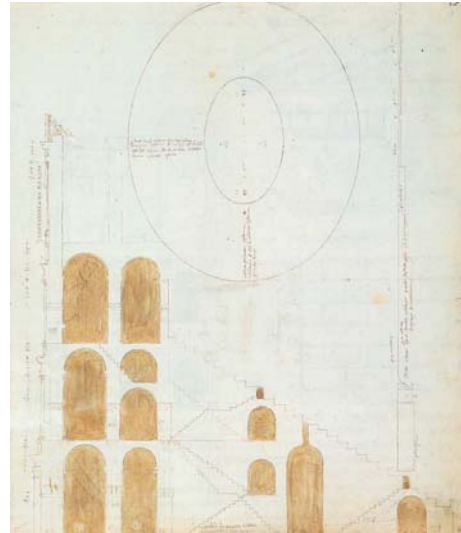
Antonio da Sangallo il Giovane. Planta y sección del Coliseo. Florencia, Uffizi
